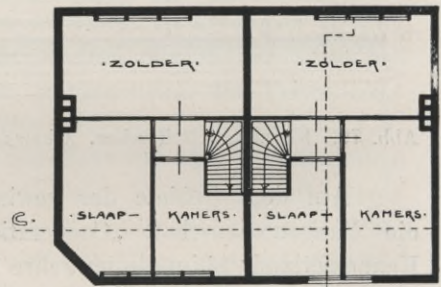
Grundriß zu Abb. 79, Obergeschoß.
